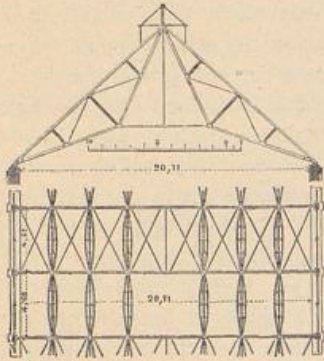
Dachkonstruktion eines Retorten-Gebäudes der städtischen Gasanstalt am Stralauer Platze.
